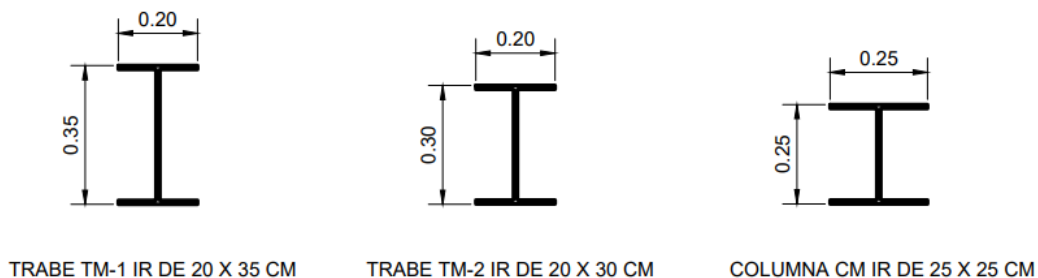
Detalles estructurales; elaboración propia, 2023.
